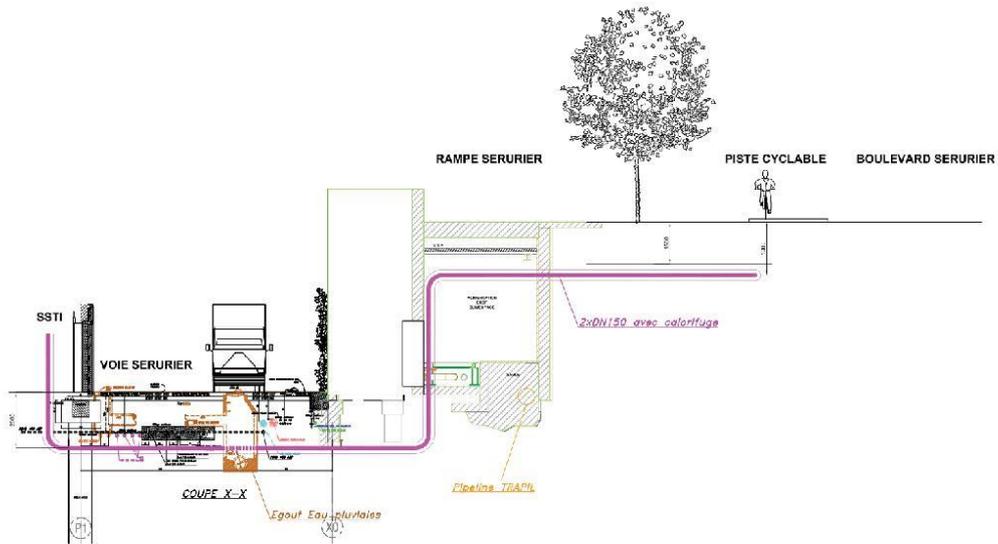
CHEMINEMENT DE LA LIAISON VERS LES PUITTS DE REINJECTION : COUPE SUR VOIE POMPIERS
